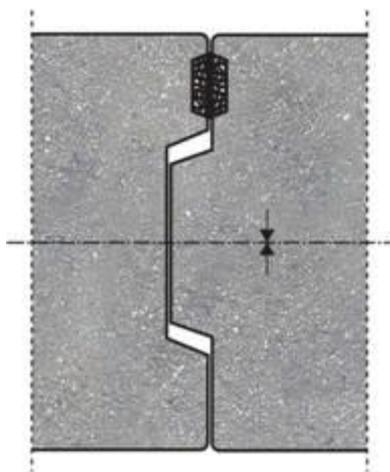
Конструкция стыка железобетонной обделки из высокоточных блоков
